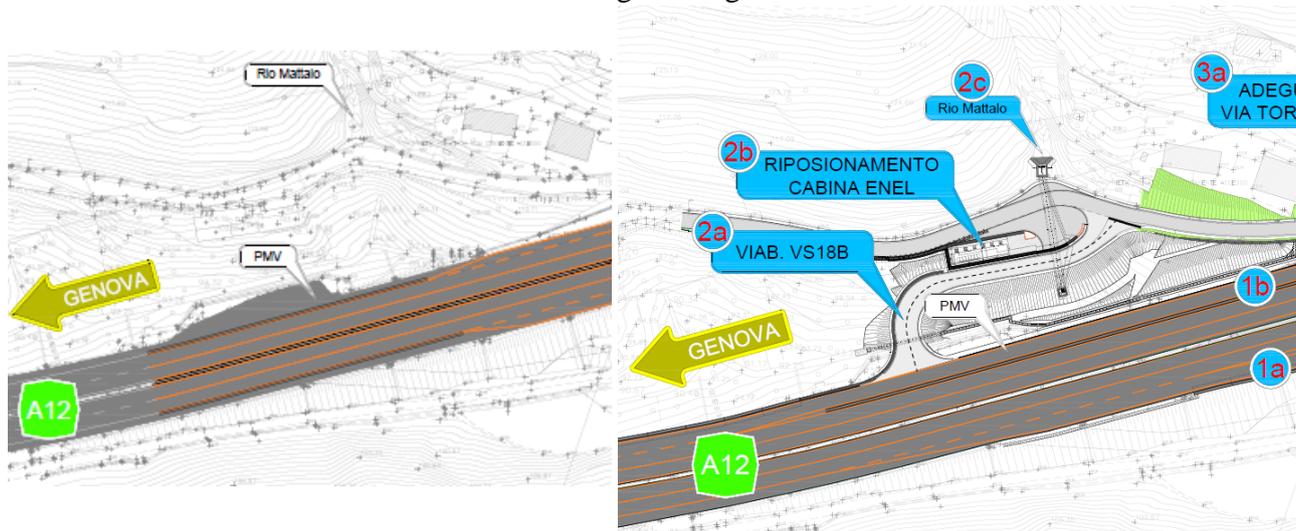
Intervento 2. A sinistra l'area oggetto di intervento da progetto sottoposto a V.I.A.; a destra planimetria dell'intervento sottoposto a Valutazione preliminare. Estratto da "tavola "raffronto tra progetto definitivo e progetto di variante Fase di cantiere" allegata alla Lista di controllo.
